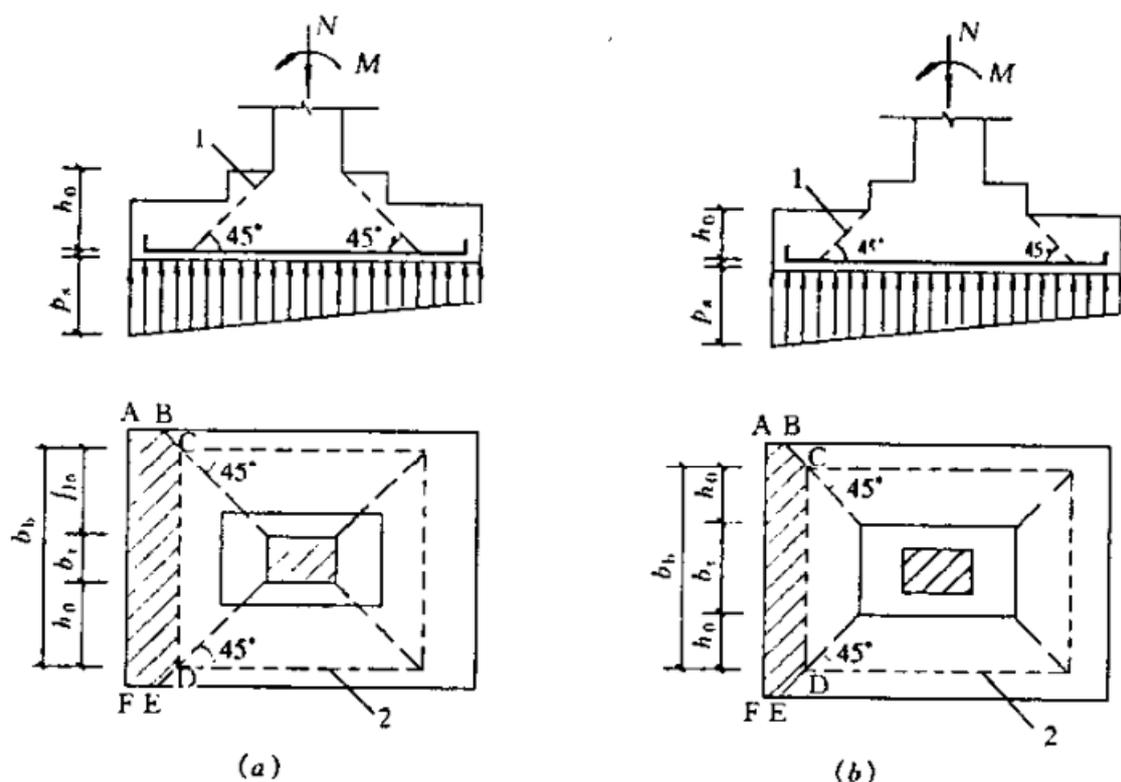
计算阶形基础的受冲切承载力截面位置
